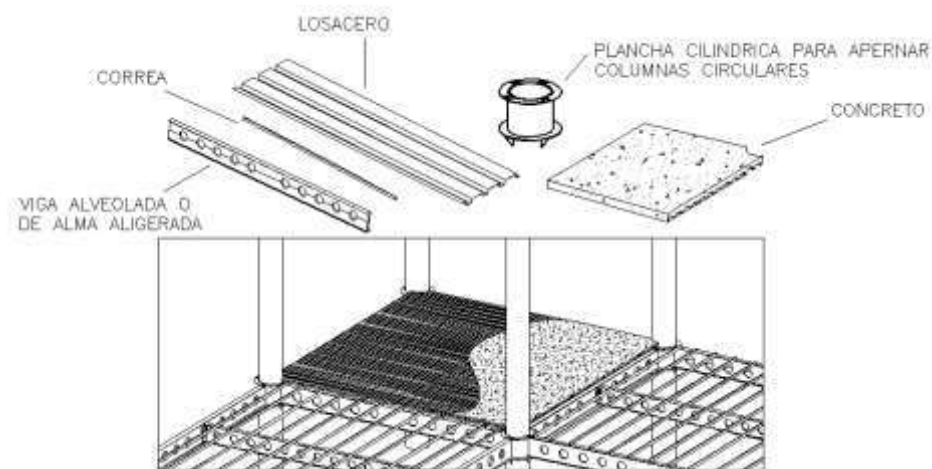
Sistema estructural Metálico típico. Fuente: <https://blog.fanosa.com>
